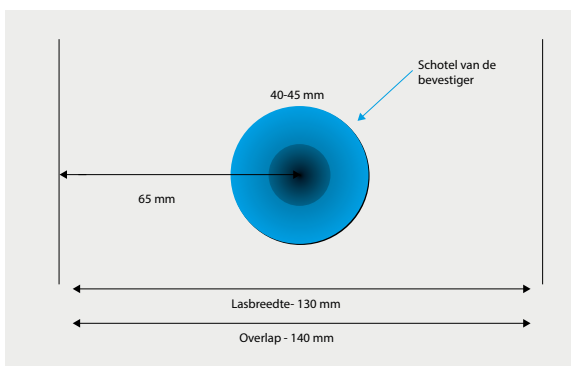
Fixation mécanique dans le joint longitudinal avec des fixations en plastique Icopal pour un chevauchement entièrement soudé.
